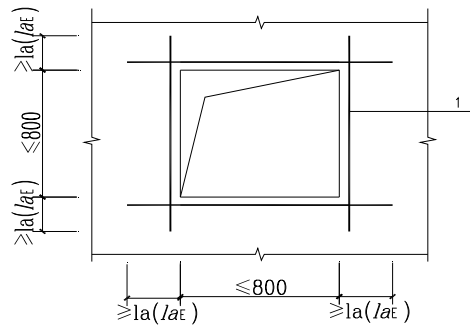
预制剪力墙洞口补强钢筋配置示意
